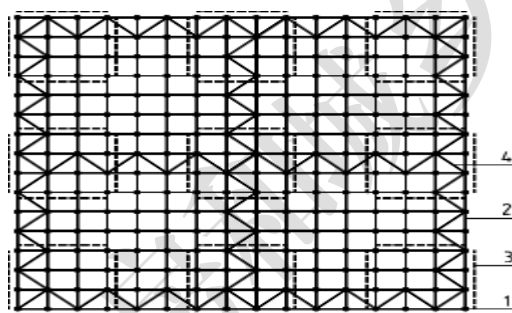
竖向塔型桁架、水平斜撑杆布置示意图
